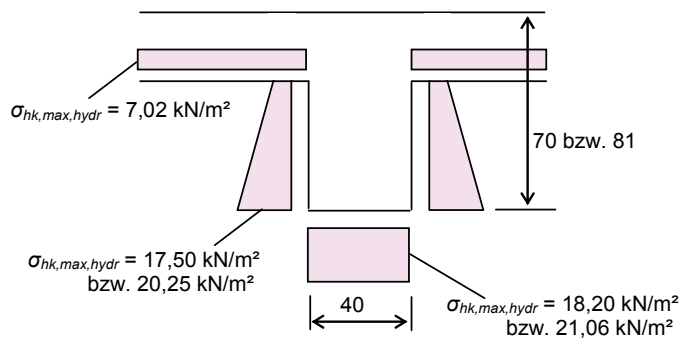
Querschnitt: Unterzug und Decke werden in einem Arbeitsgang betoniert
